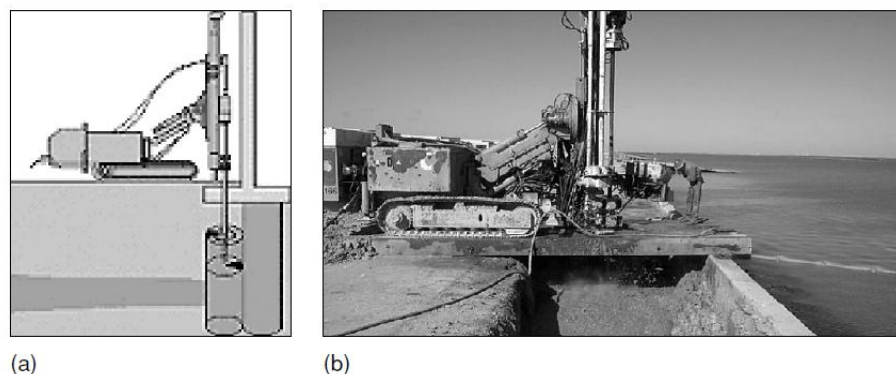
Jet Grouting: (a) esquema de uma coluna de jet grouting e (b) execução em campo. (Fonte: Hussin, 2006).
